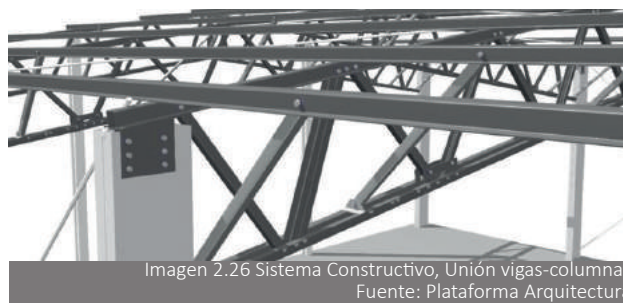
Sistema Constructivo, Unión vigas-columnas
